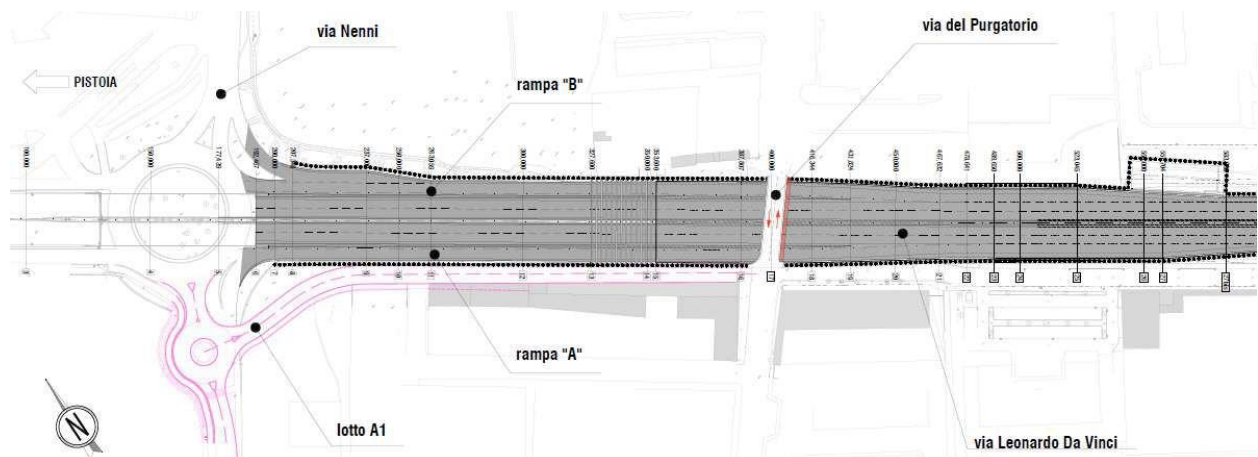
Stralcio planimetrico con individuazione delle rampe A e B
